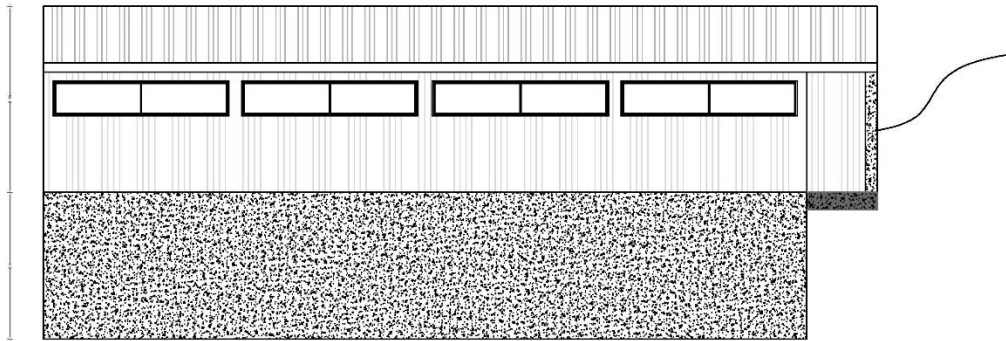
Fachada lateral de las instalaciones del taller de maquinado
